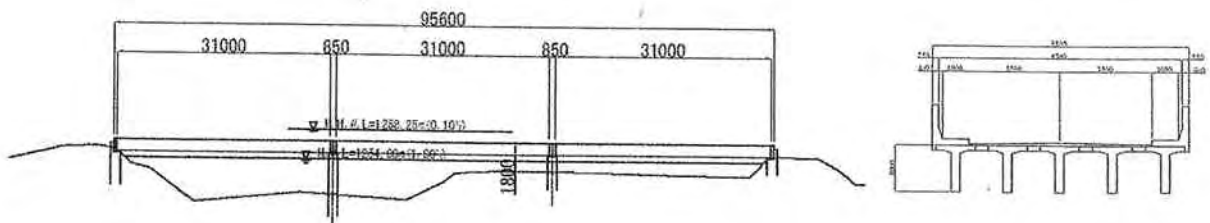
Plan du Pont à poutres en T simple avec système de précontrainte par tension après bétonnage (post-tension, longueur de travée : 31,0 m)
